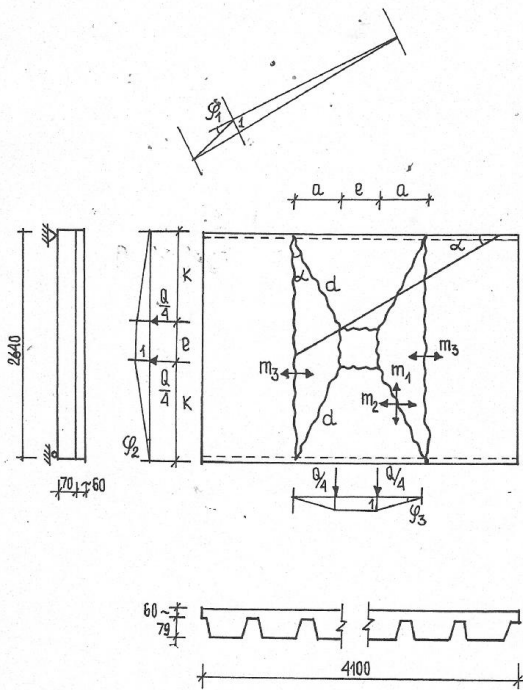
Расчет плиты перекрытий, методом предельного равновесия
